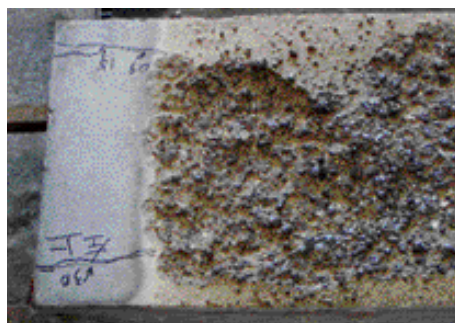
鉄筋配置の供試体の爆裂状況
